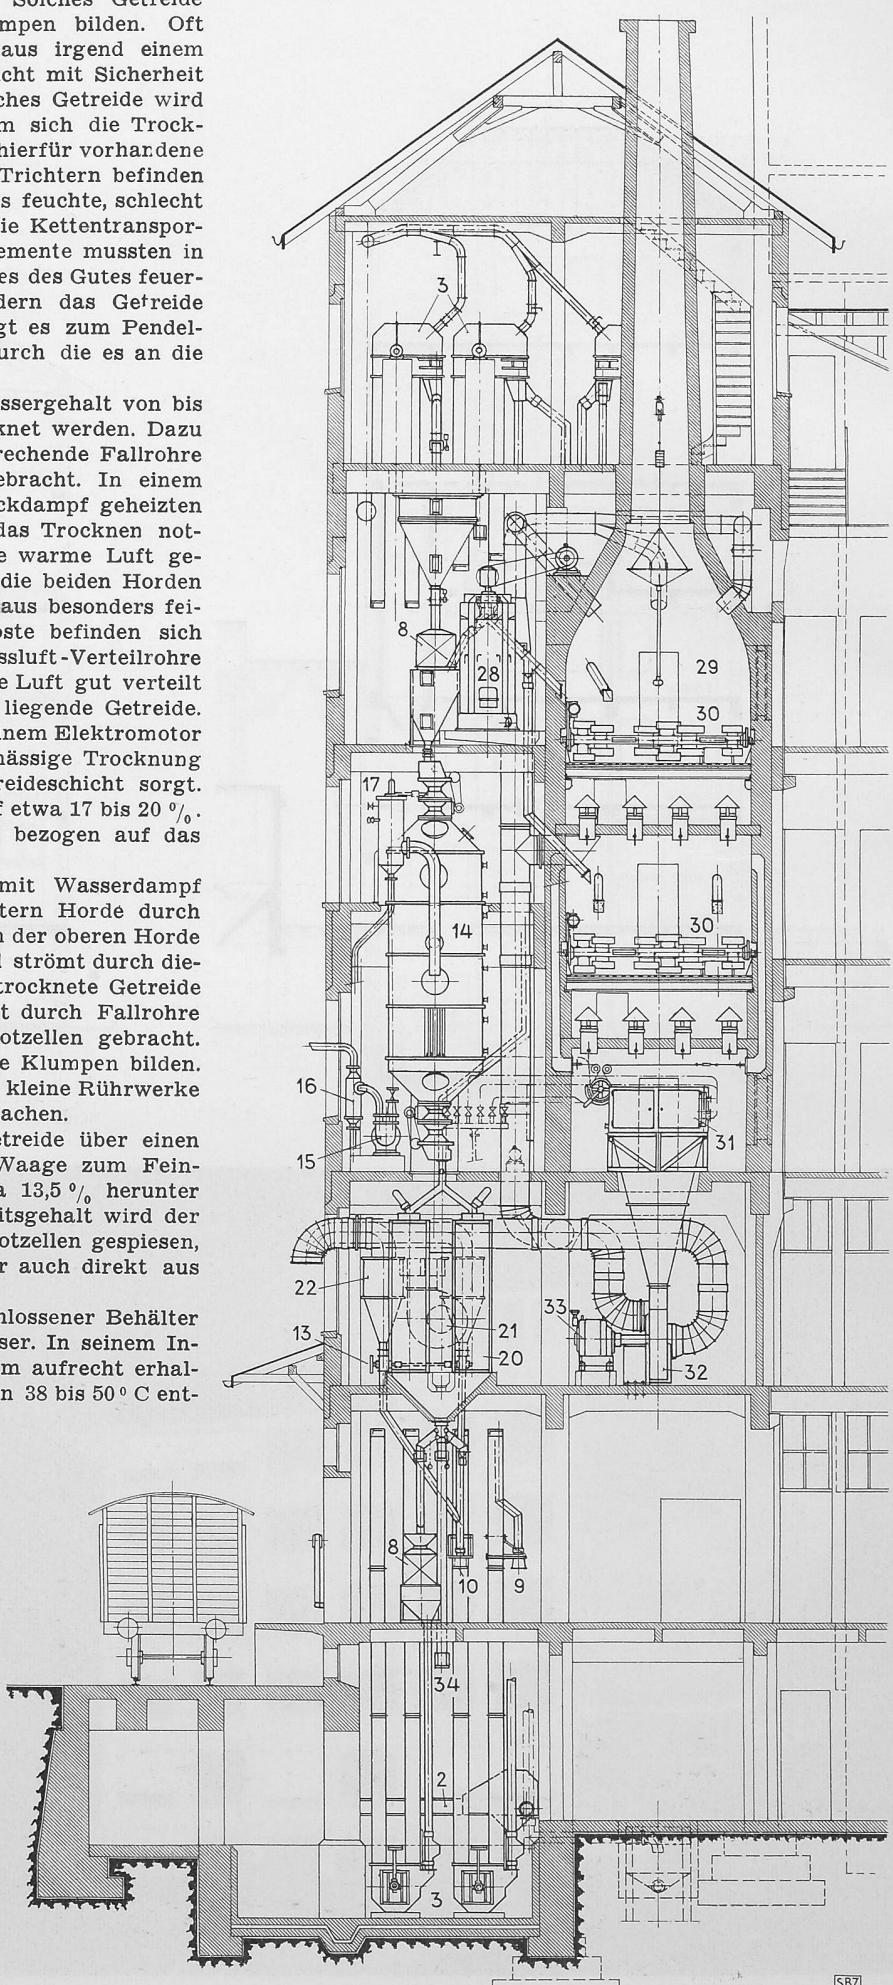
Die Getreidebehandlungsanlagen im Hochbau, Querschnitt 1:150
